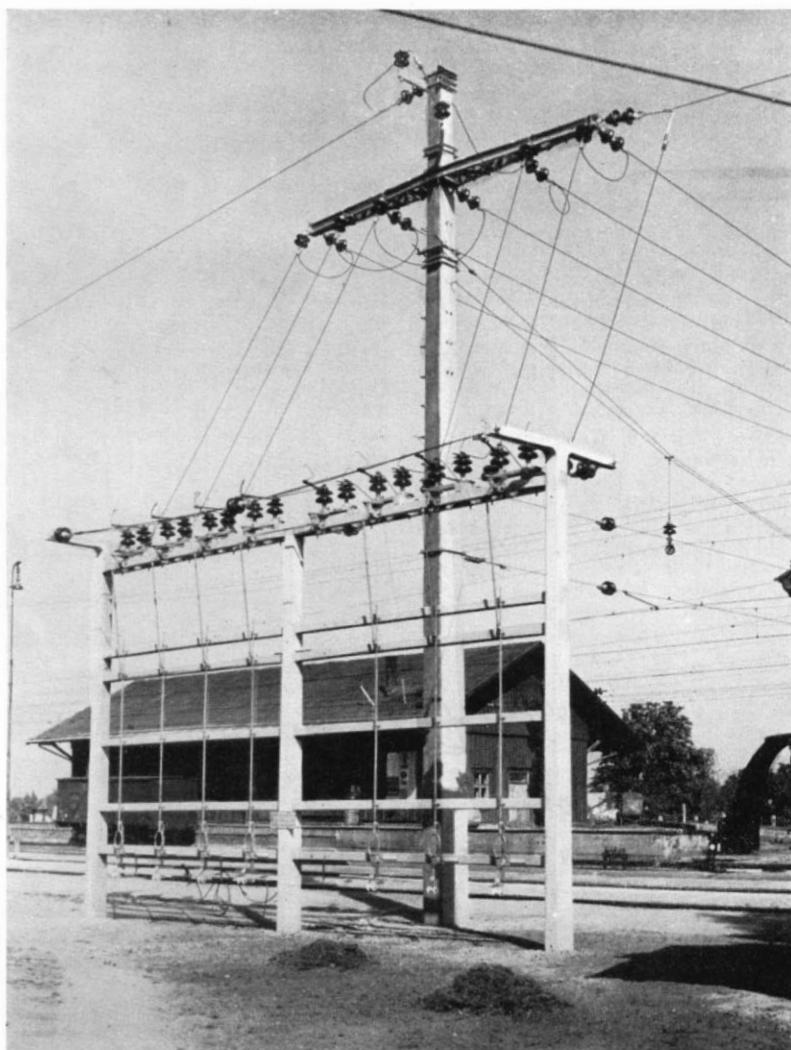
Schaltgerüst und Schalterleitungsmast in Betonbauweise im Bahnhof Leobersdorf (ÖBB-Einheitsfahrleitung 1949).
